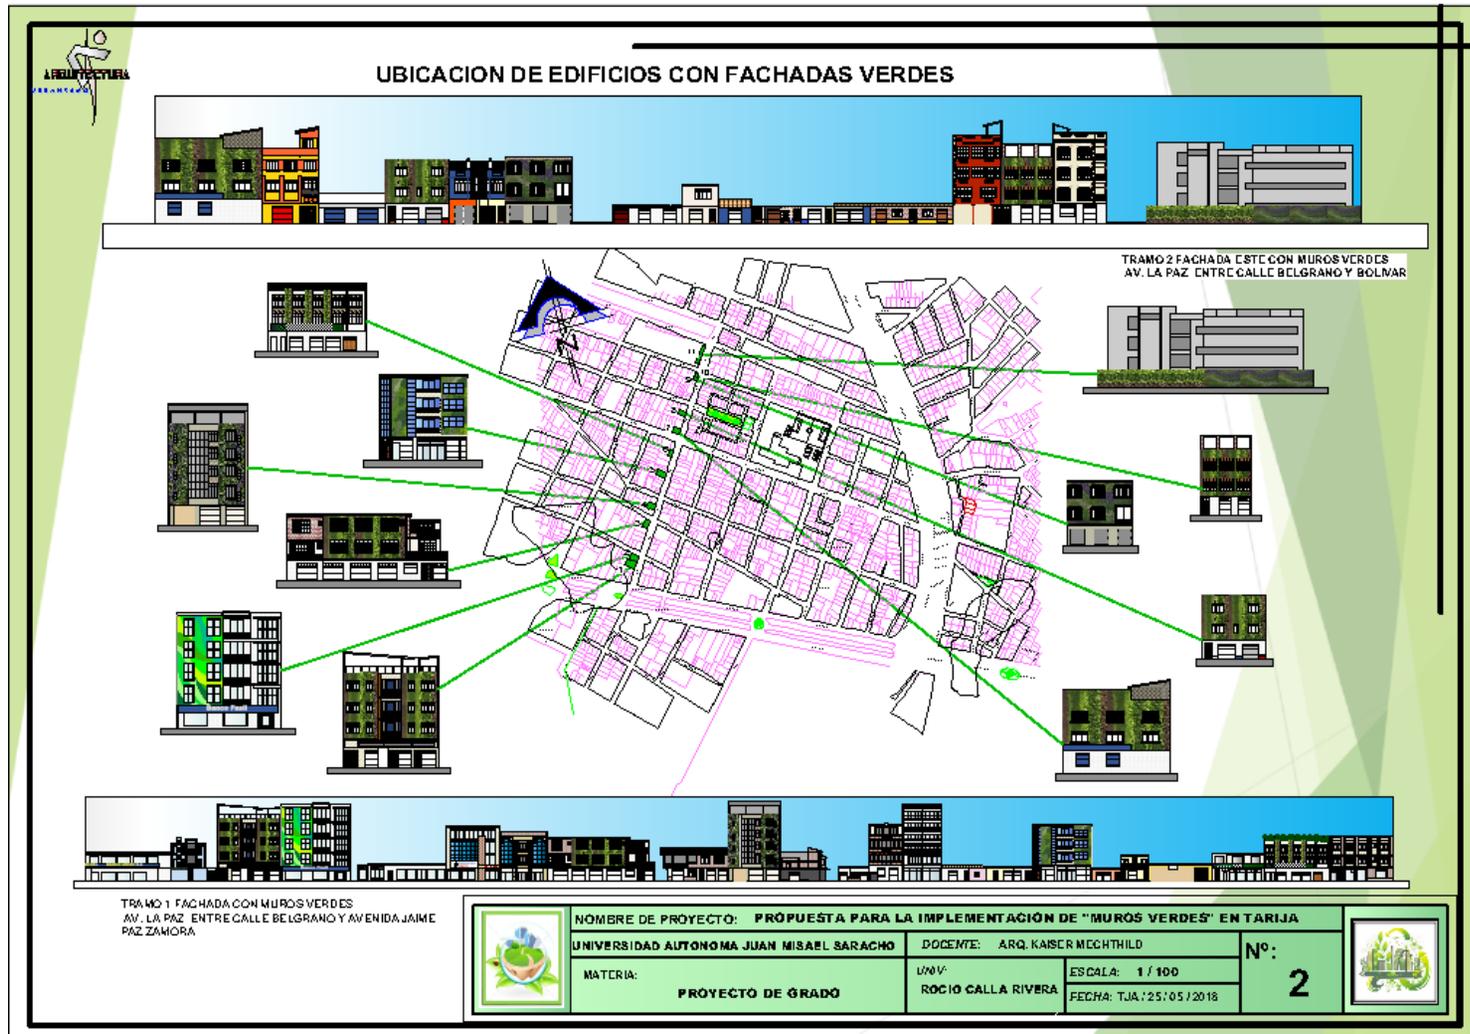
Plano con ubicación de muros verdes fachada oeste
